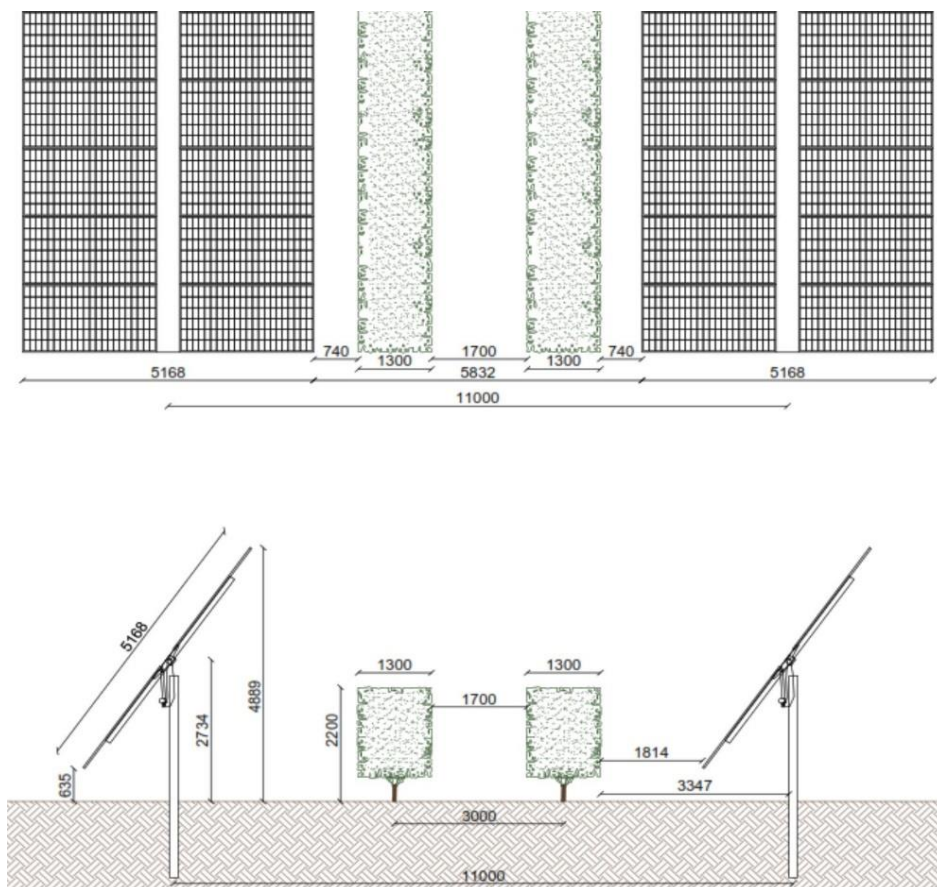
Sezione tipo dell'assetto agrovoltaico
